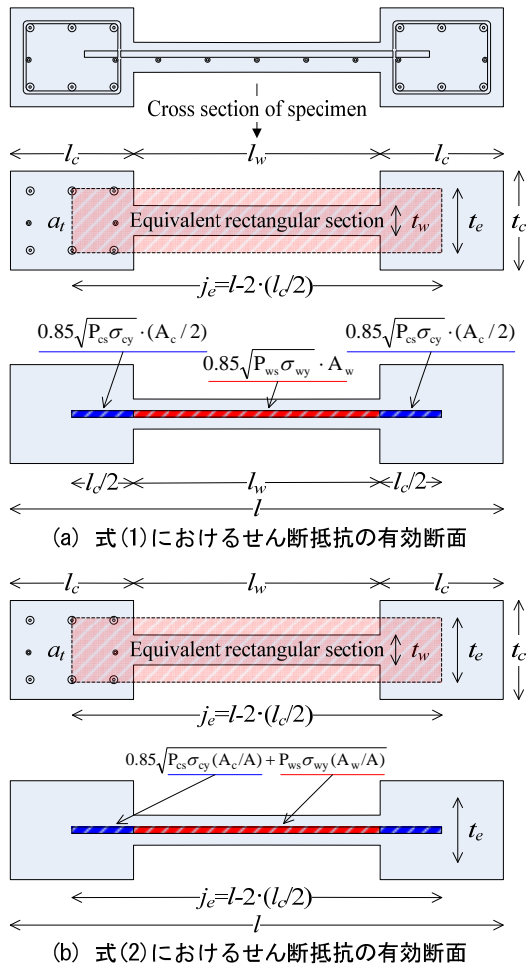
コンクリートと鉄筋のせん断抵抗の有効断面
